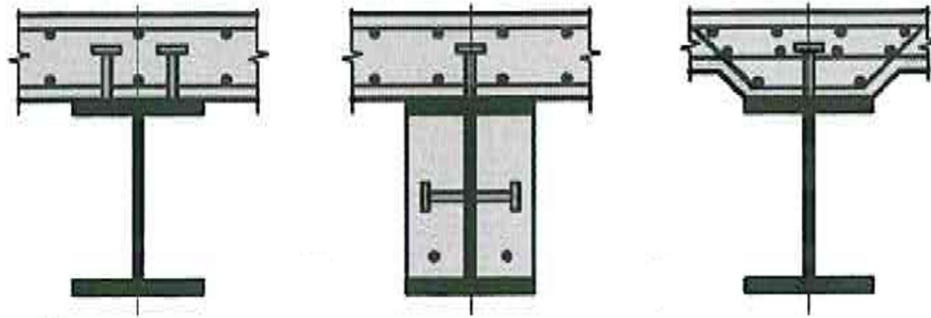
Примеры железобетонных перекрытий по стальным ригелям
